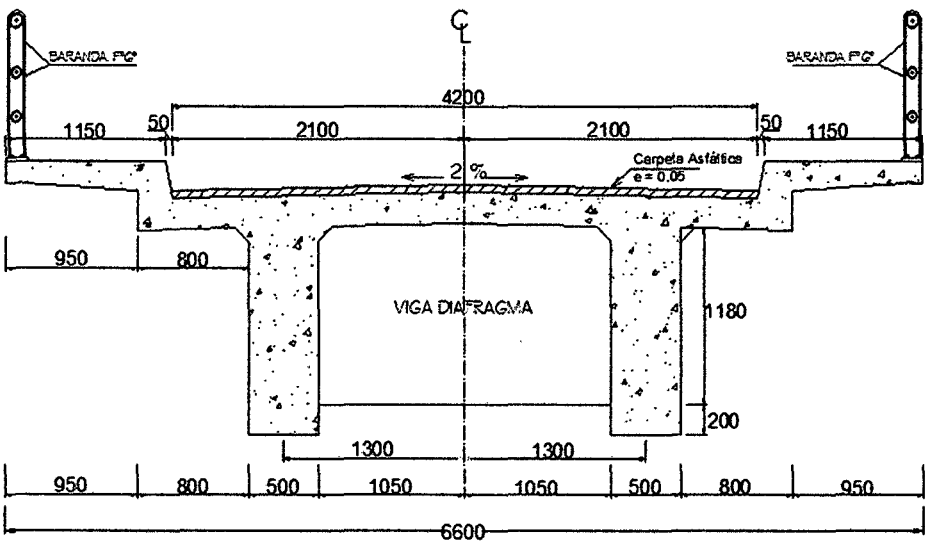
Concreto Armado – Primer y Tercer Tramo
